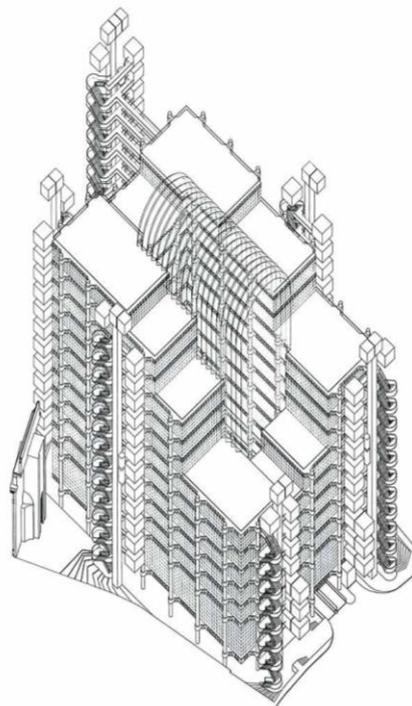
Escalonamiento del edificio para permitir el paso de luz en la cara sur (El Plan Z Arquitectura. (12 de mayo de 2012). Richard Rogers, Lloyds Bank [Ilustración]. El Plan Z Arquitectura. <http://elplanz-arquitectura.blogspot.com/2012/05/richard-rogers-lloyds-bank.html>)
